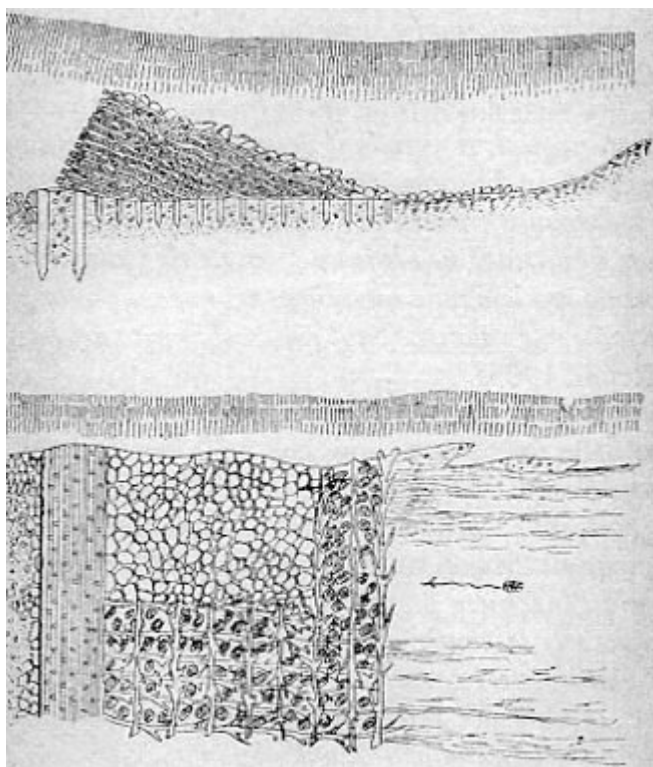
Sezione e planimetria della briglia Valentini (1912) costruita in pietrame e ramaglia
